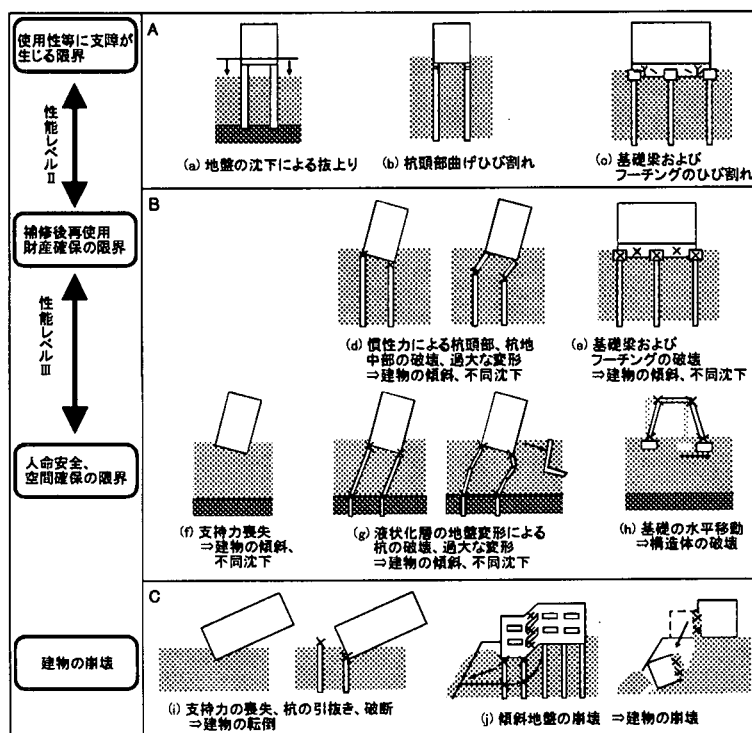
地盤に対する基礎の被害レベルの分類<sup>14)</sup>
